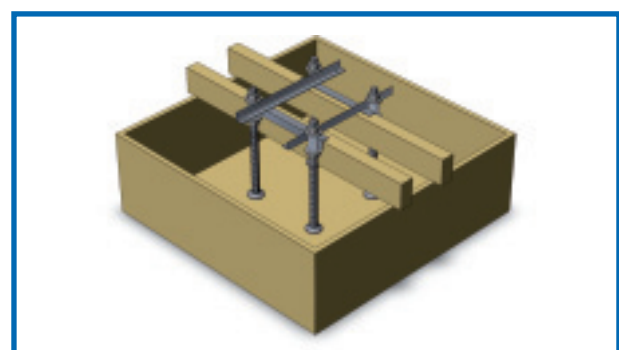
Detalle de plantilla instalación de tornillos de anclaje en cimentación.
